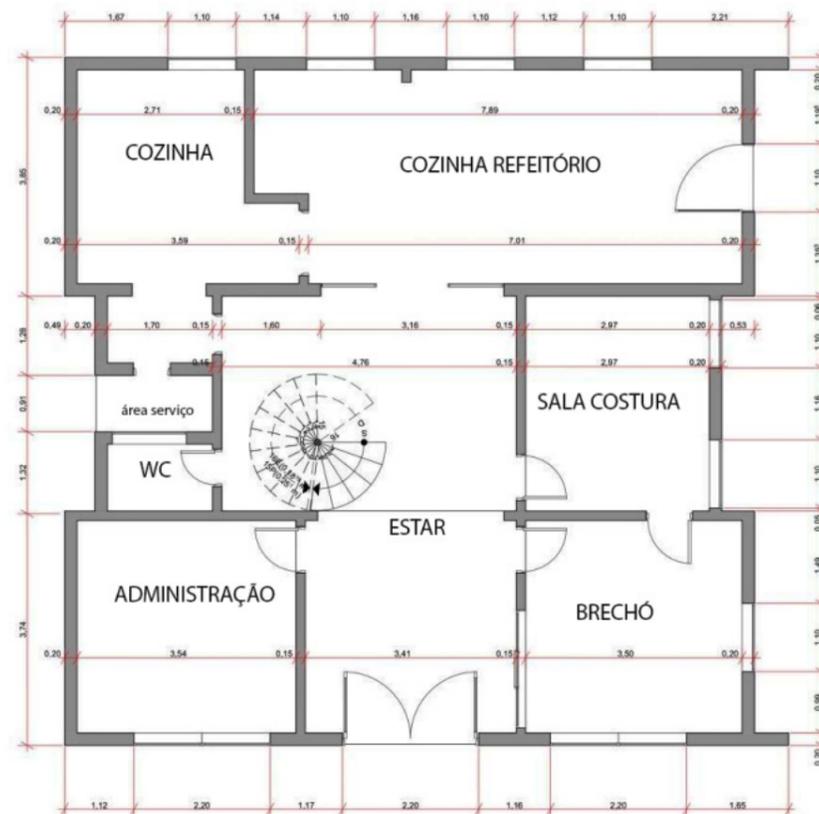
Planta baixa. Casa e Administração. Dos autores. Figura 11 - Pavimento superior. Casa e Administração. Dos autores.
